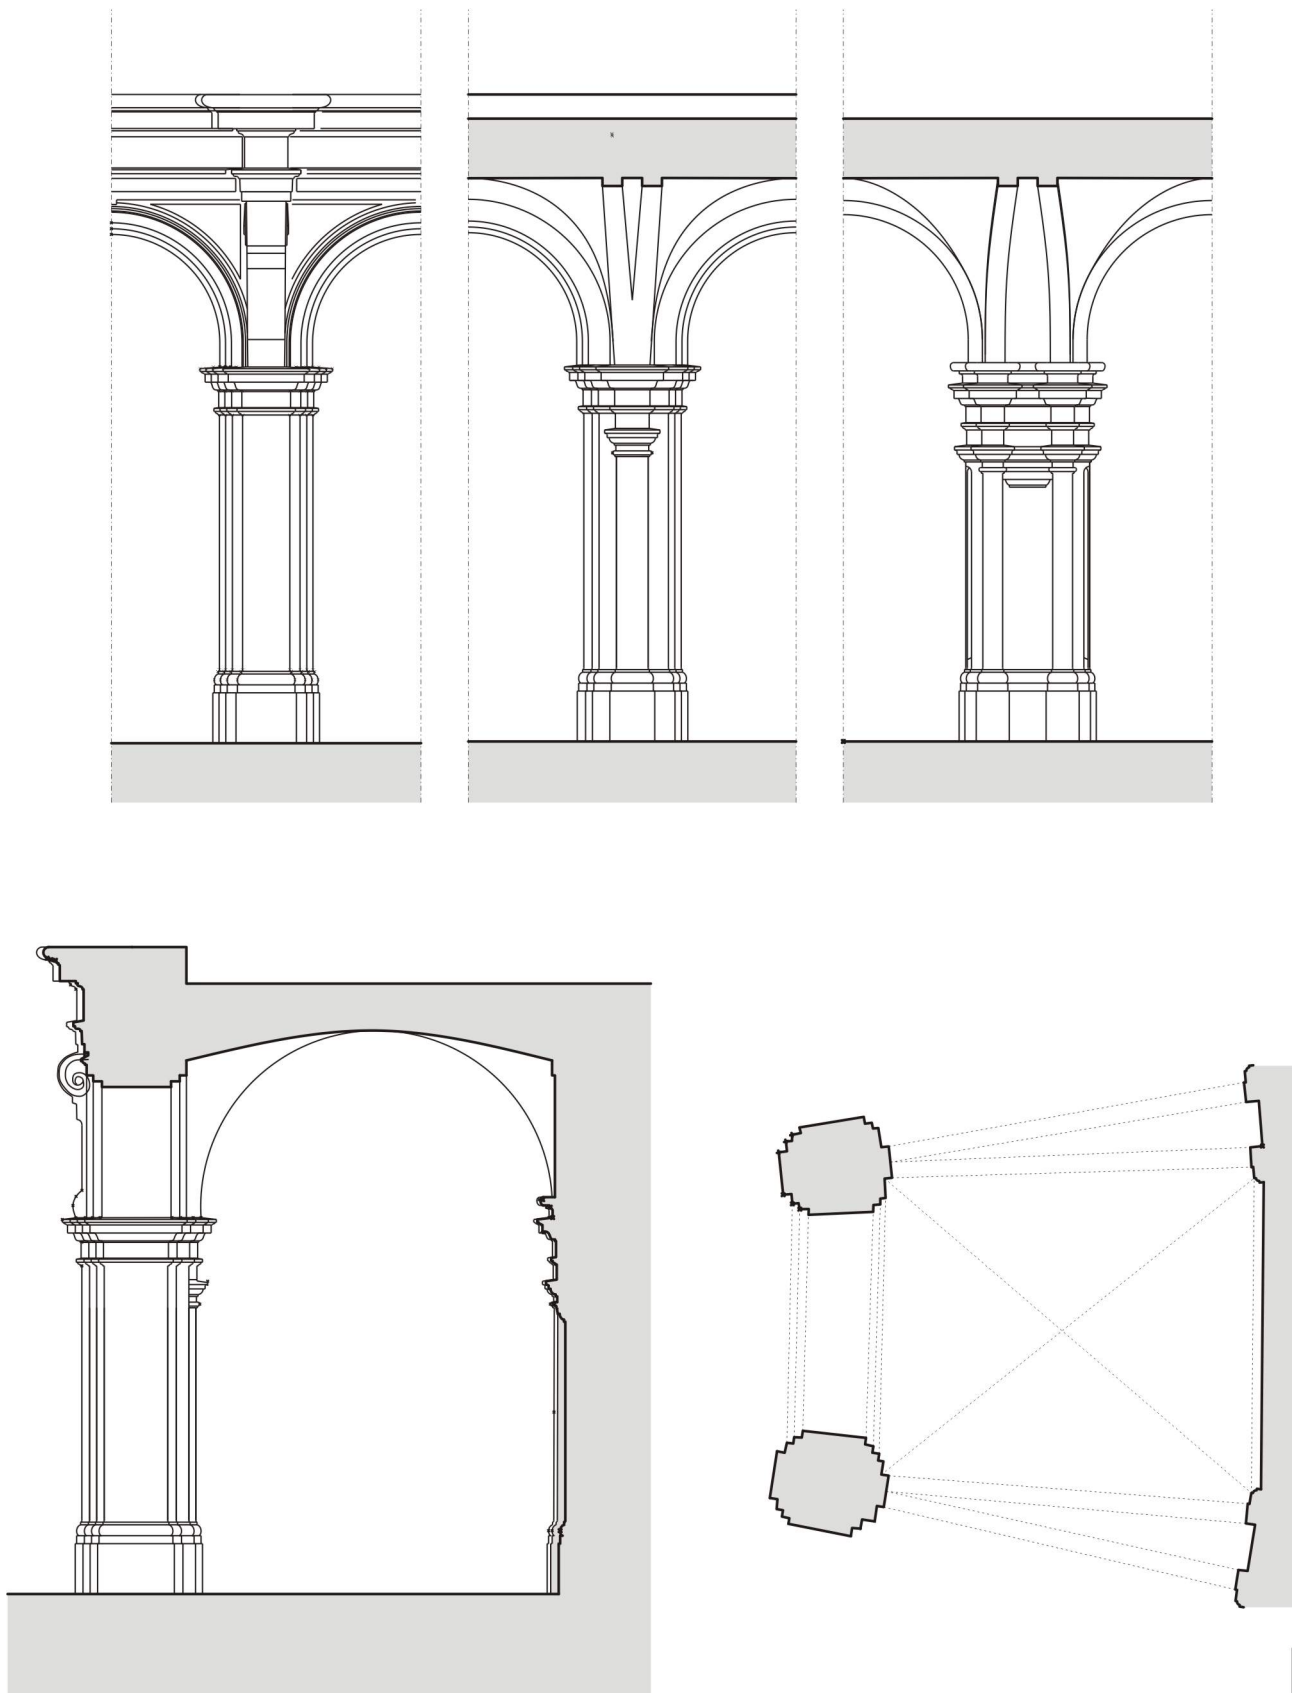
Santo Tomás, Claustro Redondo. Ansichten, Schnitte und Grundriss eines Joches.
